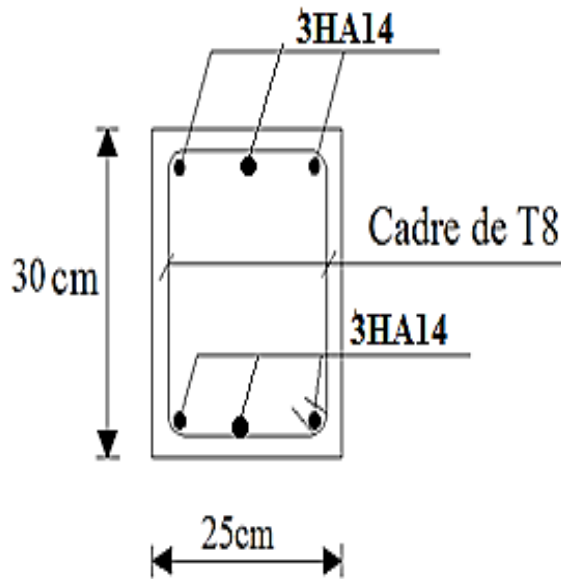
coupe A-A de ferrailage de la poutre palière
